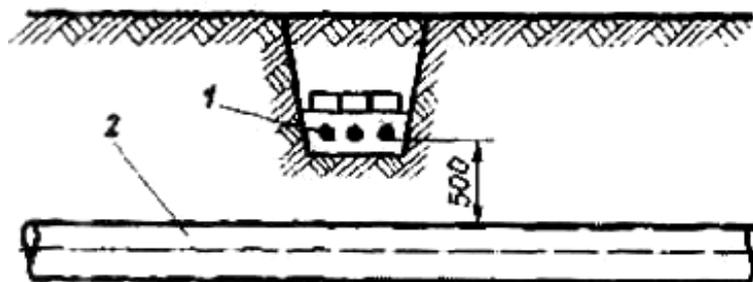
Пересечение кабелей с трубо-прово- и газопроводами: 1 – кабель до 10 кВ; 2 – трубопровод
